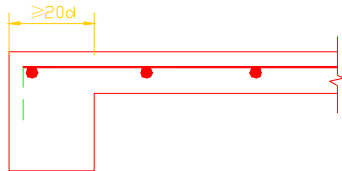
板上部钢筋焊接网与混凝土梁的连接
